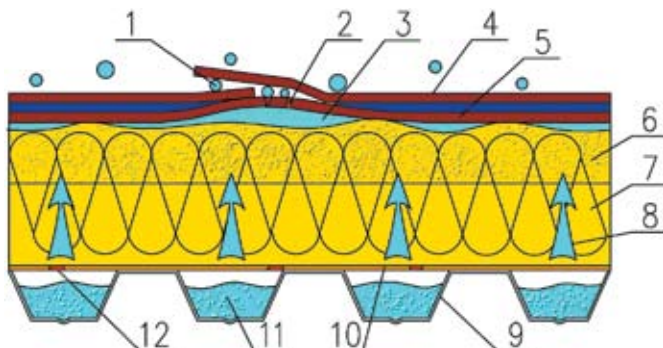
Нарушение технологии монтажа: 1 – атмосферная влага; 2 – вздутие кровли; 3 – паровоздушный карман; 4 – верхний слой гидроизоляционного ковра; 5 – нижний слой гидроизоляционного ковра; 6 – верхний слой утеплителя; 7 – нижний слой утеплителя; 8 – диффузионное движение влаги; 9 – несущий профнастил; 10 – пароизоляция; 11 – снег и лед в пазах профнастила; 12 – повреждения пароизоляции
